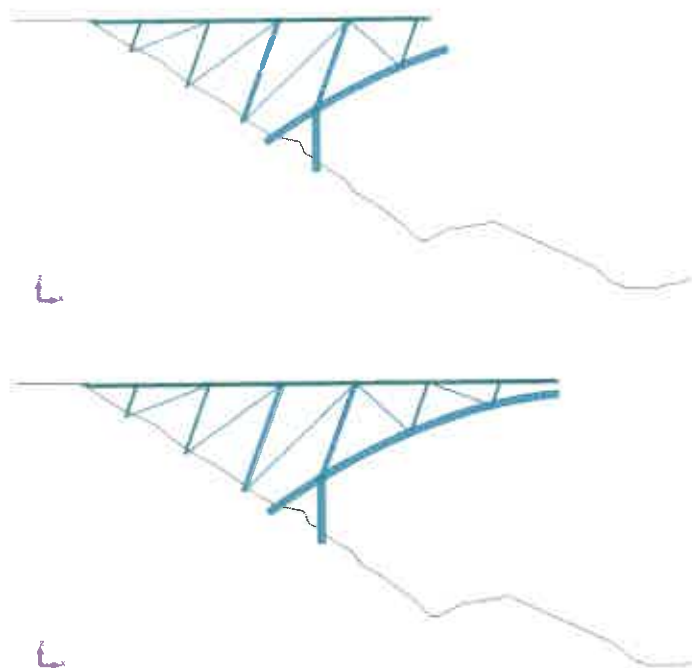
Alçado esquemático da sequência construtiva da Ponte
